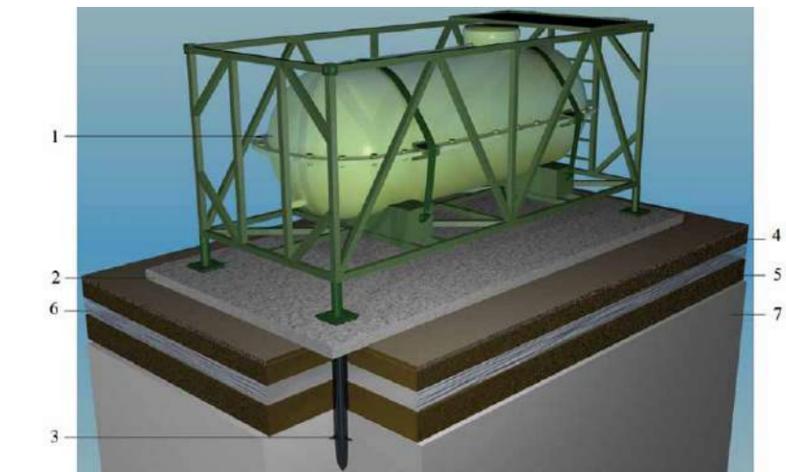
Установка контейнер-цистерны на бетонной площадке с применением свай: 1 – резервуар; 2 – бетонная площадка; 3 – металлическая винтовая свая; 4, 5 – слой почвы; 6 – вечномёрзлый грунт; 7 – скальная порода
